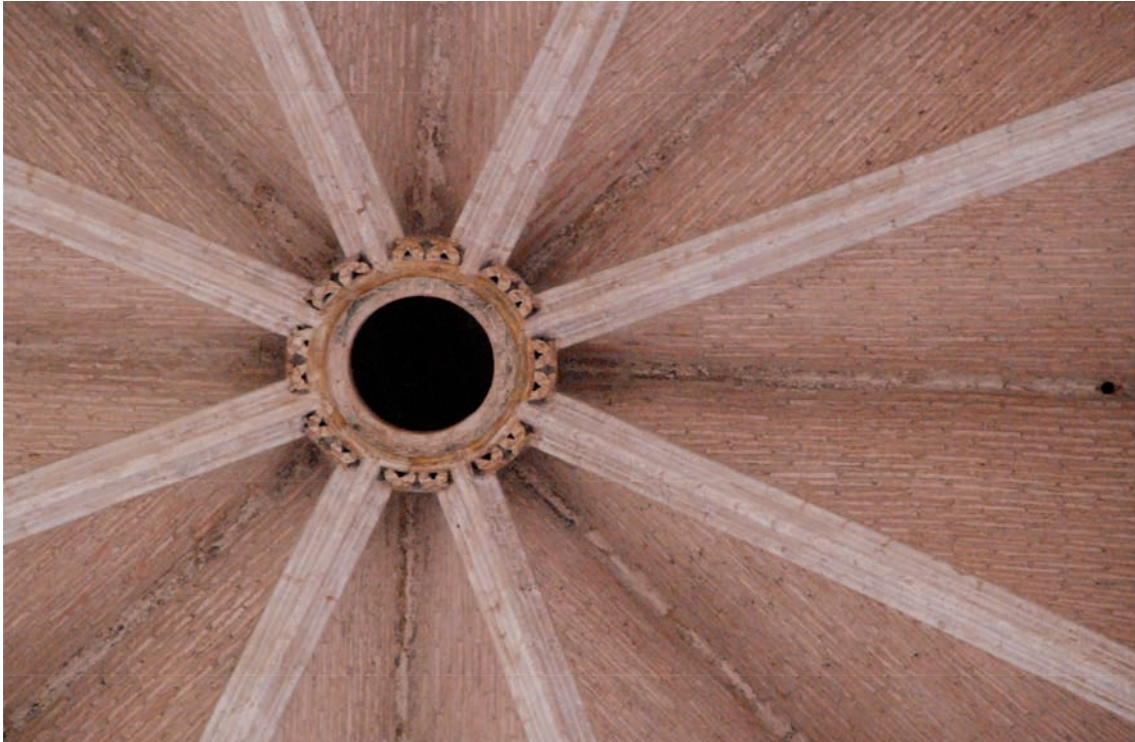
Detalle de la clave de piedra y la plementería de ladrillo.
